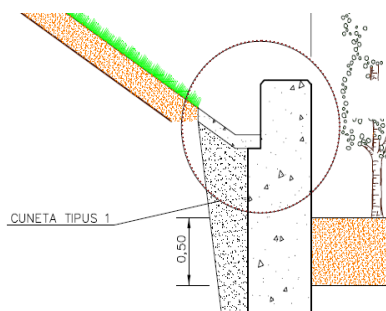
Plànol 14 full 3 Secció núm.3 – destacat detall de cuneta-mur.
